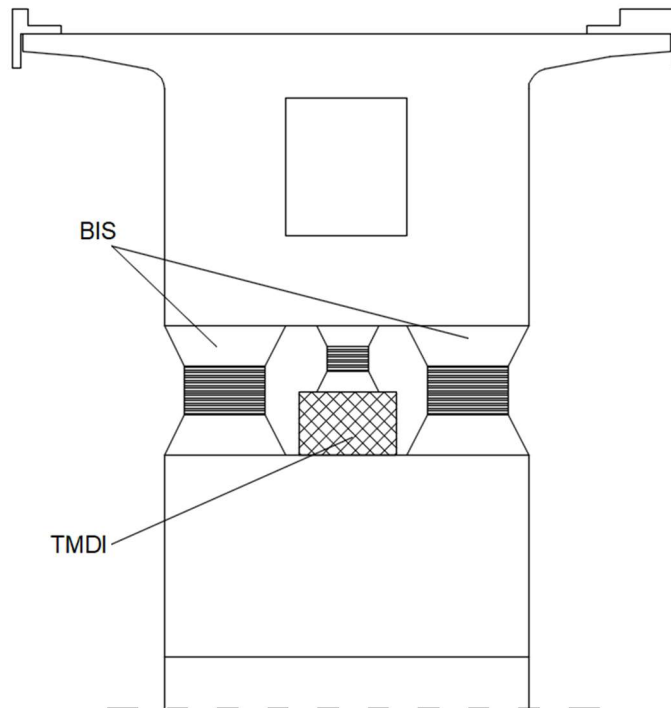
Sezione pila con installazione TMDI e sistema di isolamento (BIS) tra pila e impalcato
